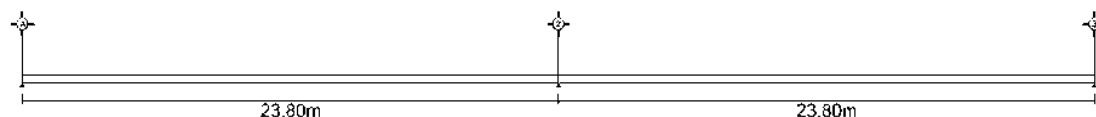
(b) Sistema de trabes de liga, eje transversal
